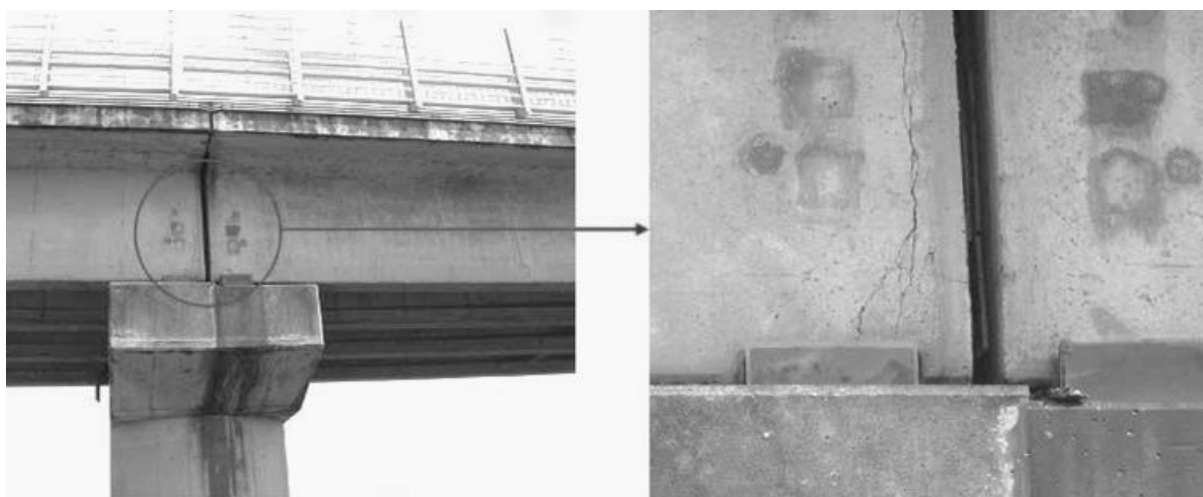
Fissuras na extremidade de vigas principais.
